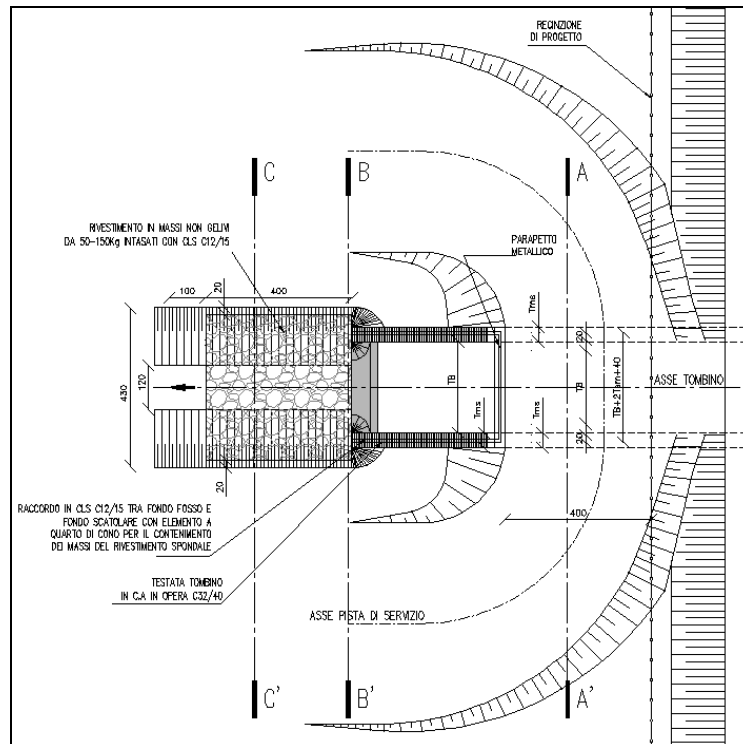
PLANIMETRIA IMBOCCO/SBOCCO CONSORZIO DI BONIFICA TERRE DI GONZAGA IN DESTRA PO
